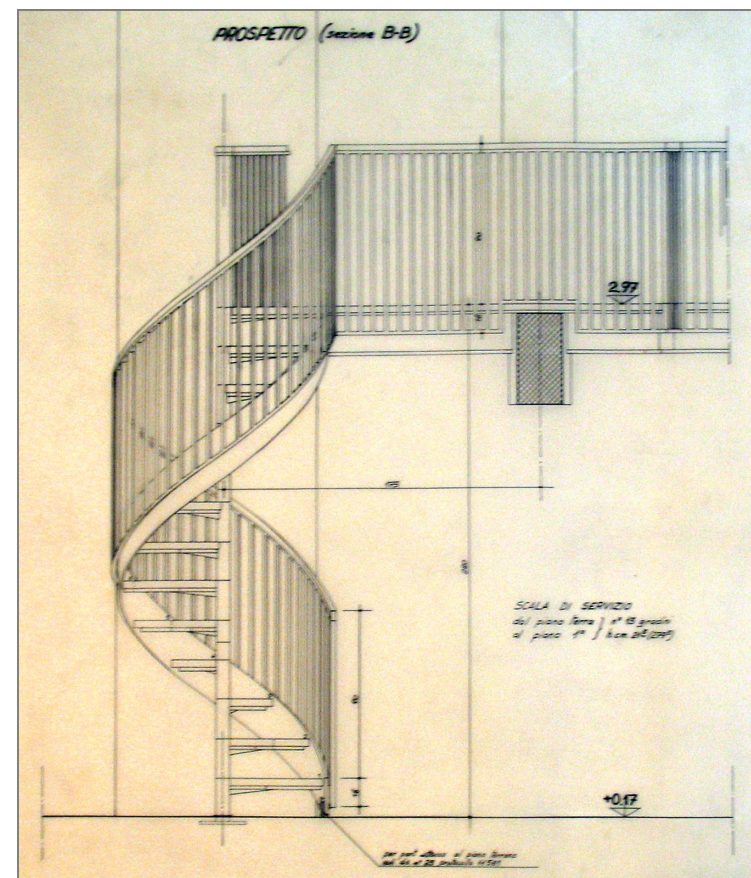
scala di servizio: prospetto (fonte CSAC – stralcio tav. 29, archivio n. 276-1)
